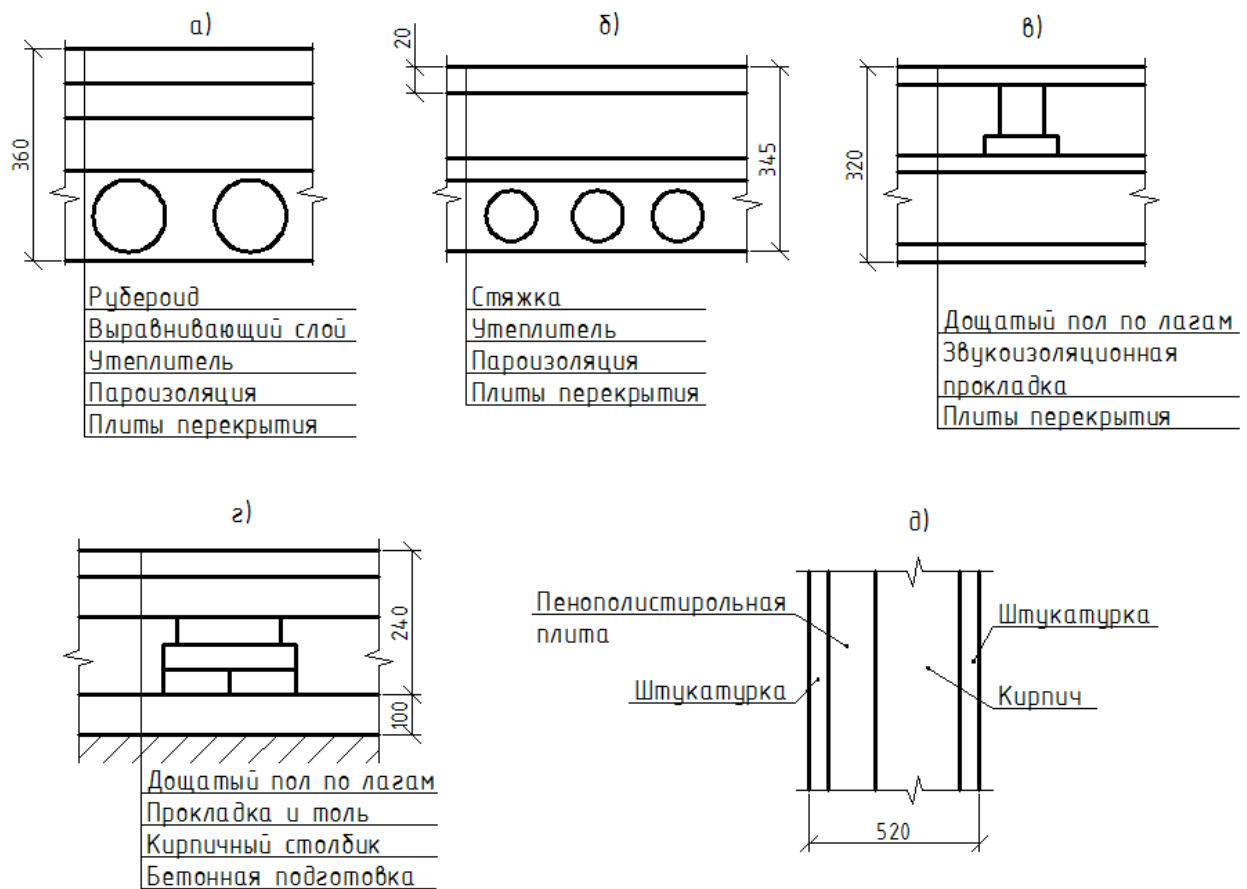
Конструкция перекрытий и стен: а – бесчердачного; б – чердачного; в – междуэтажного; г – пола первого этажа по грунту; д – стены
